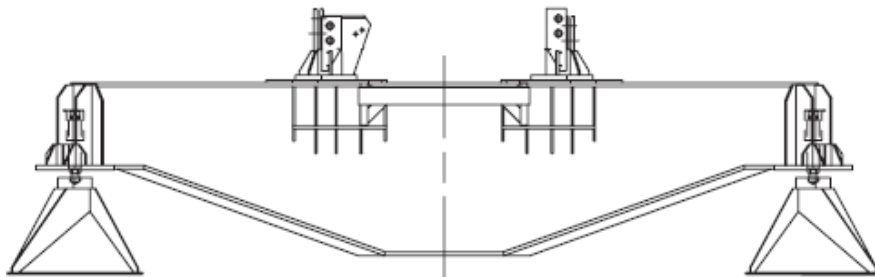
Base metálica para grúa apoyada.
